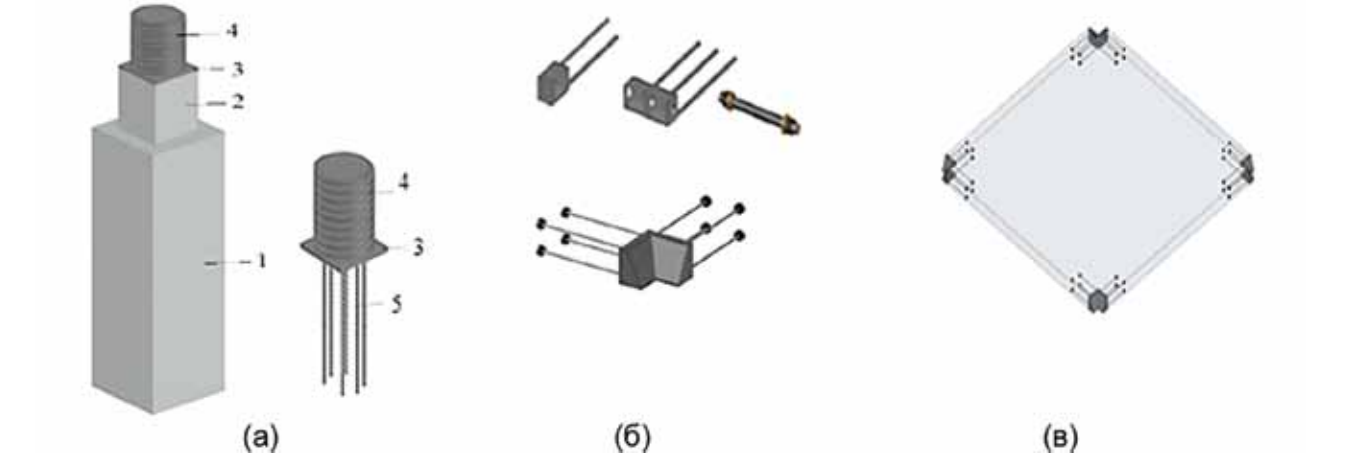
а) Колонны: 1 – нижняя часть колонны, 2 – верхняя часть колонны, 3 – закладные детали, 4 – цилиндрическое винтовое соединение, 5 – деформированные стальные стержни; б) Закладные детали в углах плиты перекрытия и закладные детали в углах ригеля; в) Плита перекрытия
